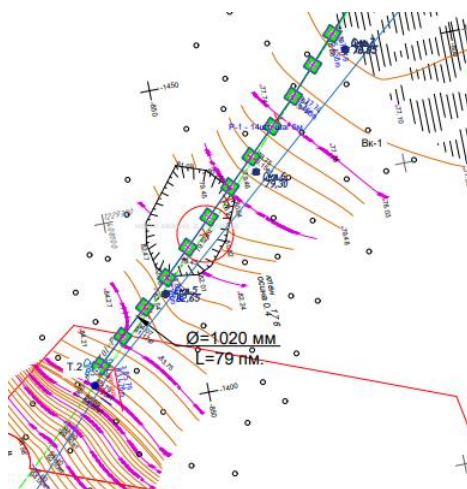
План монолитных железобетонных ростверков по напорный трубопровод  $d=1020,0$  мм.
